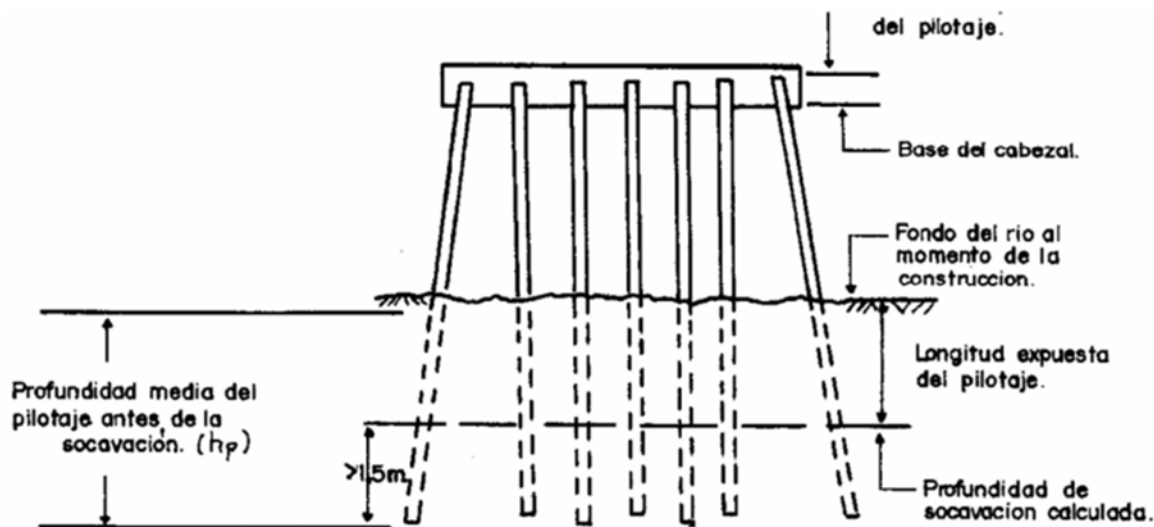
Diseño de pilotes trabajando por punta considerando efecto de socavación. (Flemming, 1994)
